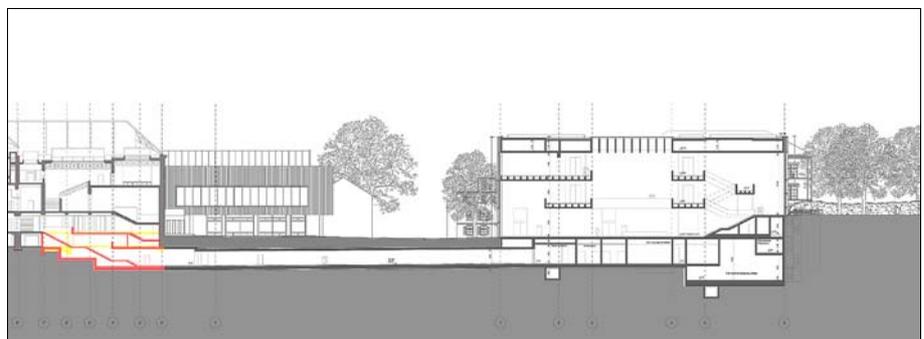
Kunsthaus-Erweiterung Gebäudeschnitt, David Chipperfield Architects, Berlin, Stand Richtprojekt März 2011
